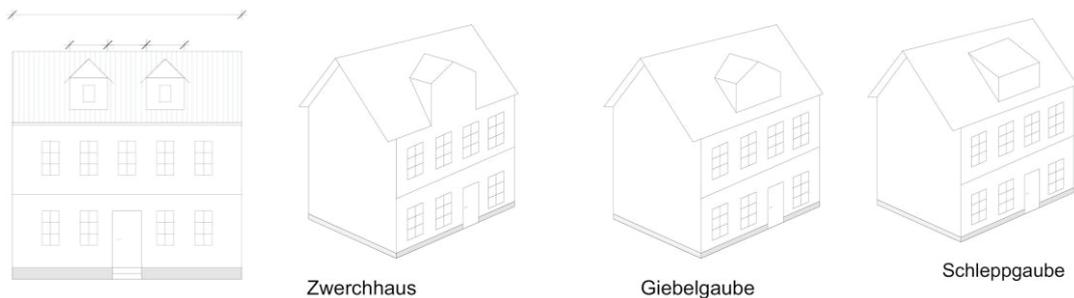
Die Breite der Dachaufbauten darf max. 2/3 der Fassadenbreite betragen. Dachaufbauten müssen mind. 1 m Abstand untereinander und zur Gebäudeaußenkante halten.
